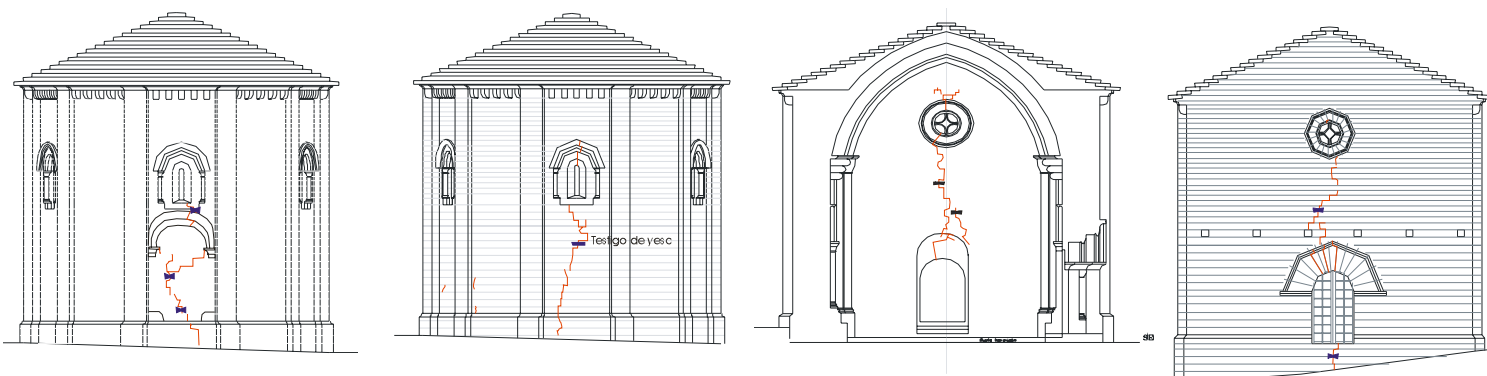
Fisuras detectadas en el interior y exterior de los alzados Oeste y Este respectivamente.
